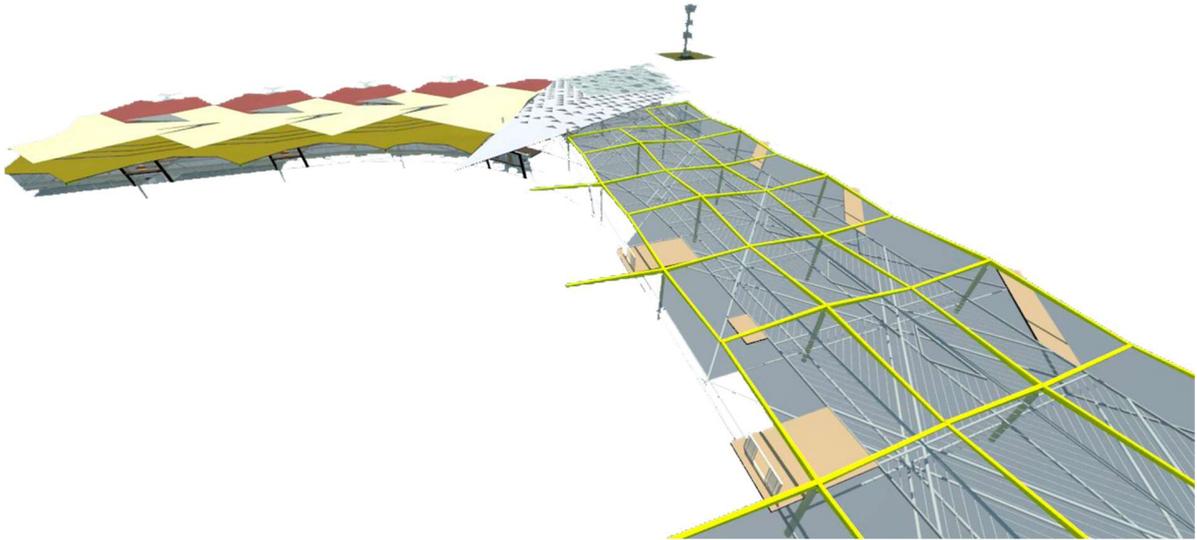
Estructura Aeropuerto del Llano. Fuente: Autores
